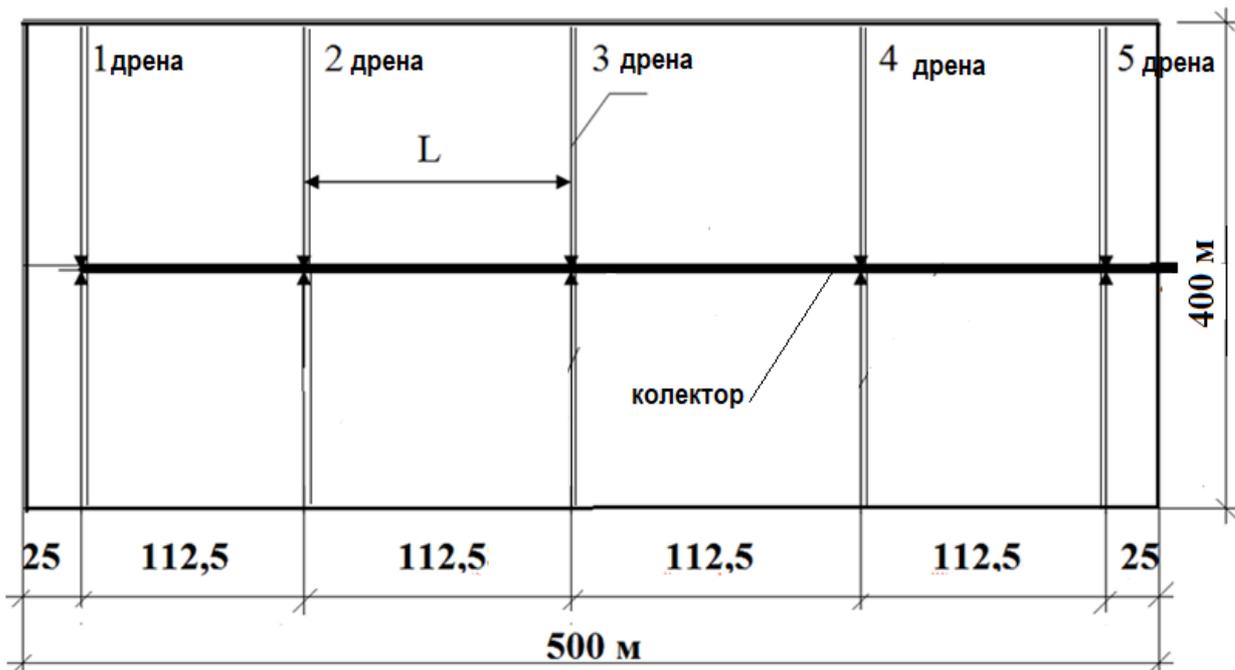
Схема дрен в плані (приклад 1)
